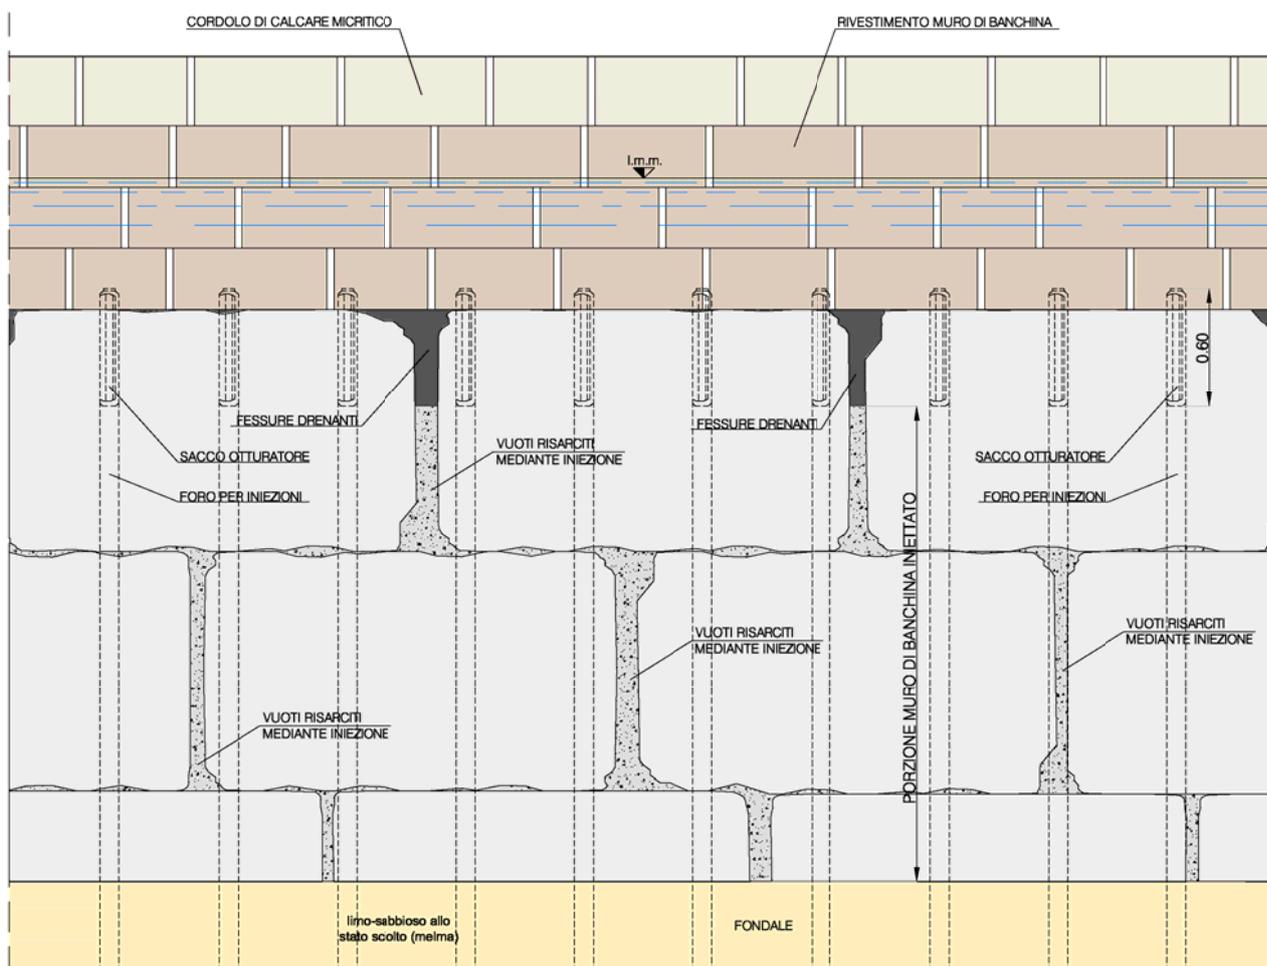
Drenaggio realizzato mediante contenimento delle iniezioni con sacco otturatore – Prospetto
